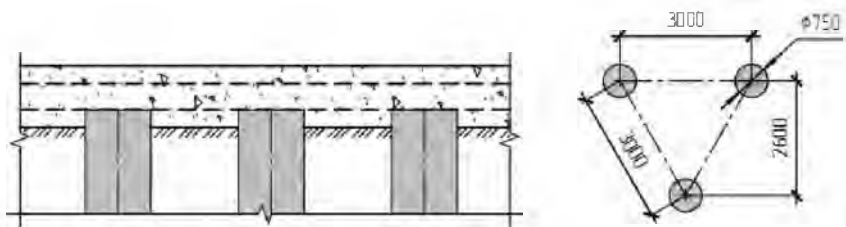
Схема укрепления основания грунтоцементными колоннами
